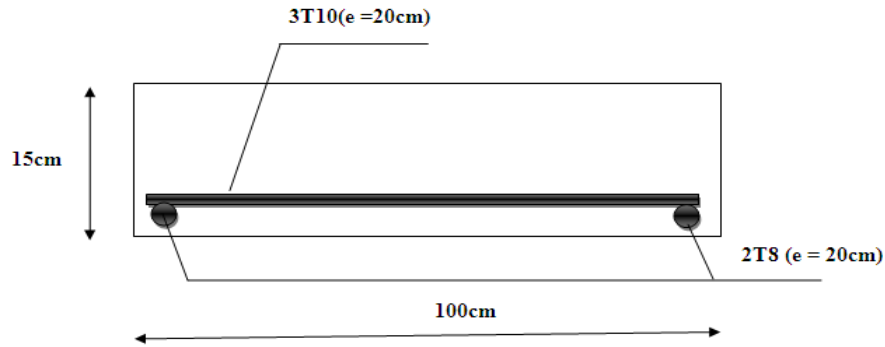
Schéma de ferrailage de l'escalier en appuis.
